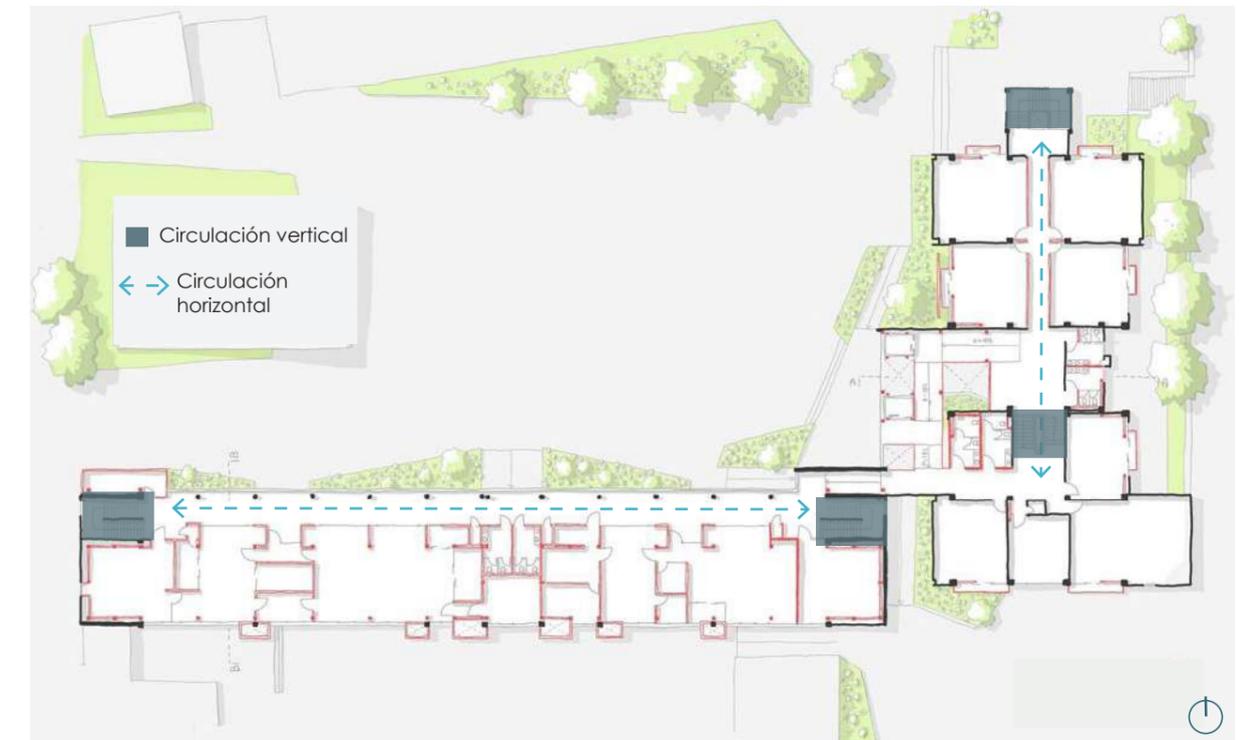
Recorridos entre bloques Fuente: Modificado de Baq 2022
